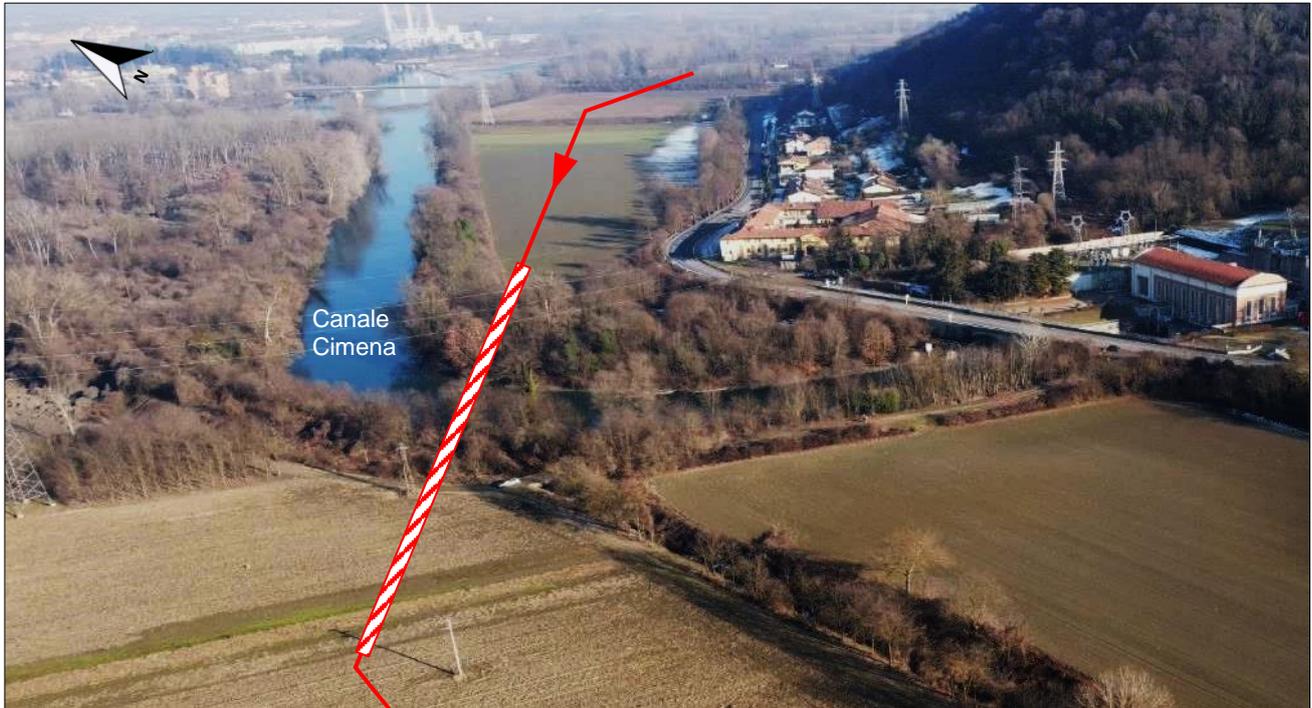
Trenchless n. 2 - Attraversamento Canale Cimena
